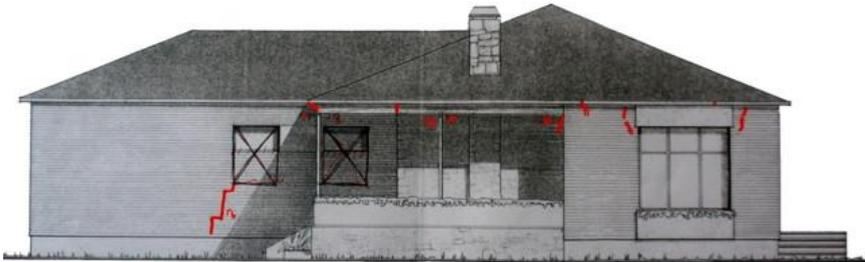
Levantamiento de fisuras. Año 2012. Fuente: elaboración propia.
